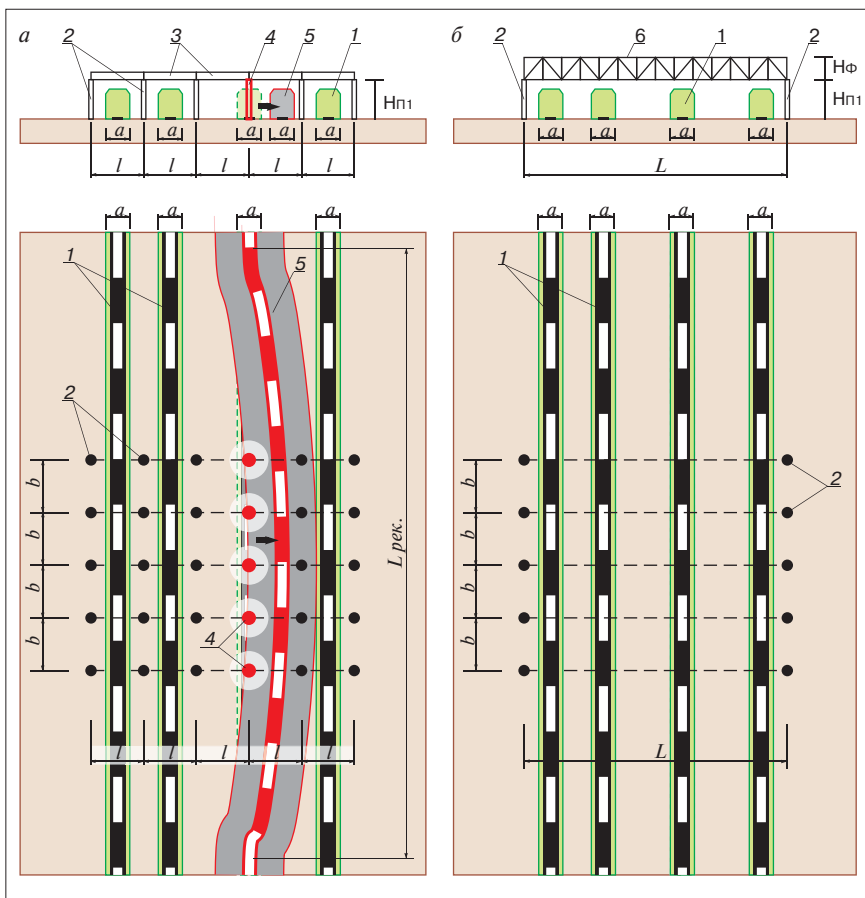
Схемы размещения вертикальных несущих конструкций: а — при использовании перекрытий с малым шагом несущих опор; б — при использовании большепролетных ферм: 1 — габарит пространства поезда; 2 — опора несущей конструкции; 3 — перекрытие с малым пролетом горизонтальной несущей конструкции; 4 — опора, попадающая в габарит пространства поезда; 5 — габарит пространства поезда, смещенный после реконструкции рельсового полотна; 6 — большепролетная ферма (до 72 м) горизонтальной несущей конструкции; а — ширина габарита пространства поезда (5,5 м); l — длина перекрытия с малым пролетом; L — длина большепролетных ферм; b — шаг опор вдоль железных дорог; L рек. — длина реконструкции рельсового полотна; НП1 — высота эксплуатируемого пространства для железных дорог; НФ — высота фермы
